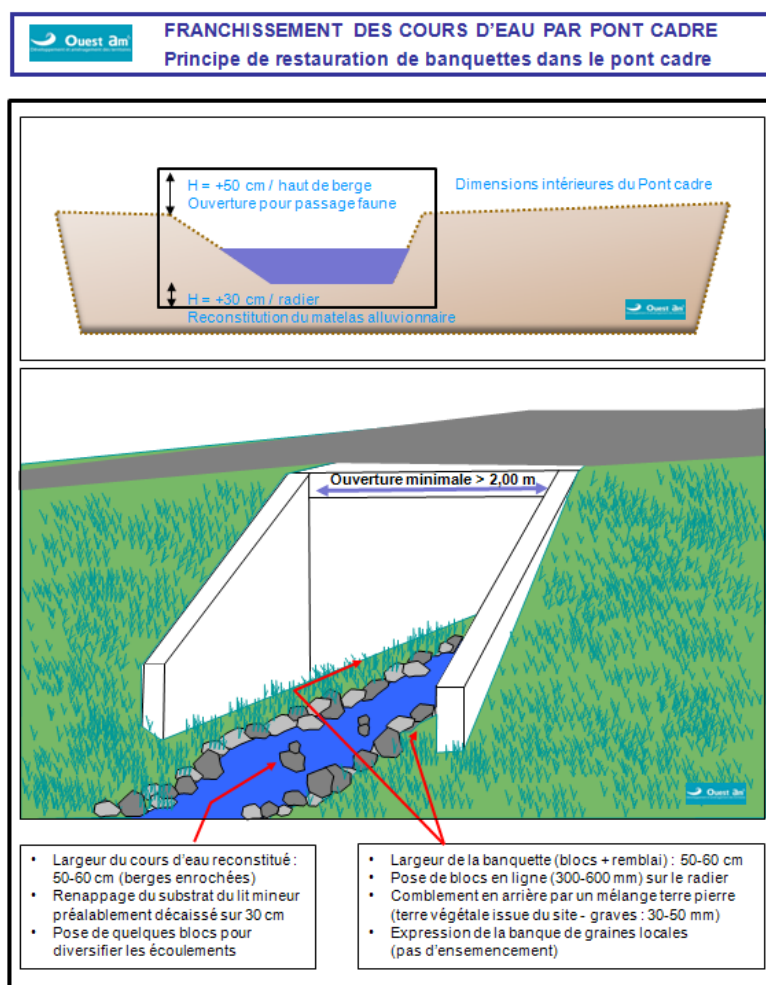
Schéma type de pont-cadre avec banquette (non nécessaire)
